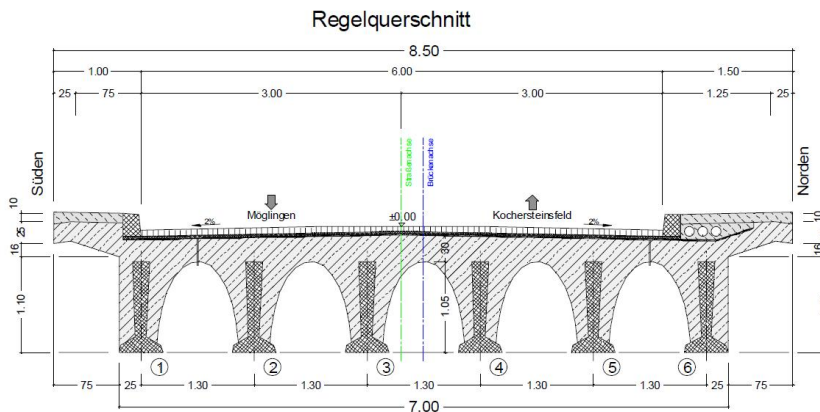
Brückenquerschnitt mit einbetonierten Spannbeton-Fertigteilträgern aus Tonerdeschmelz-zement [12]
